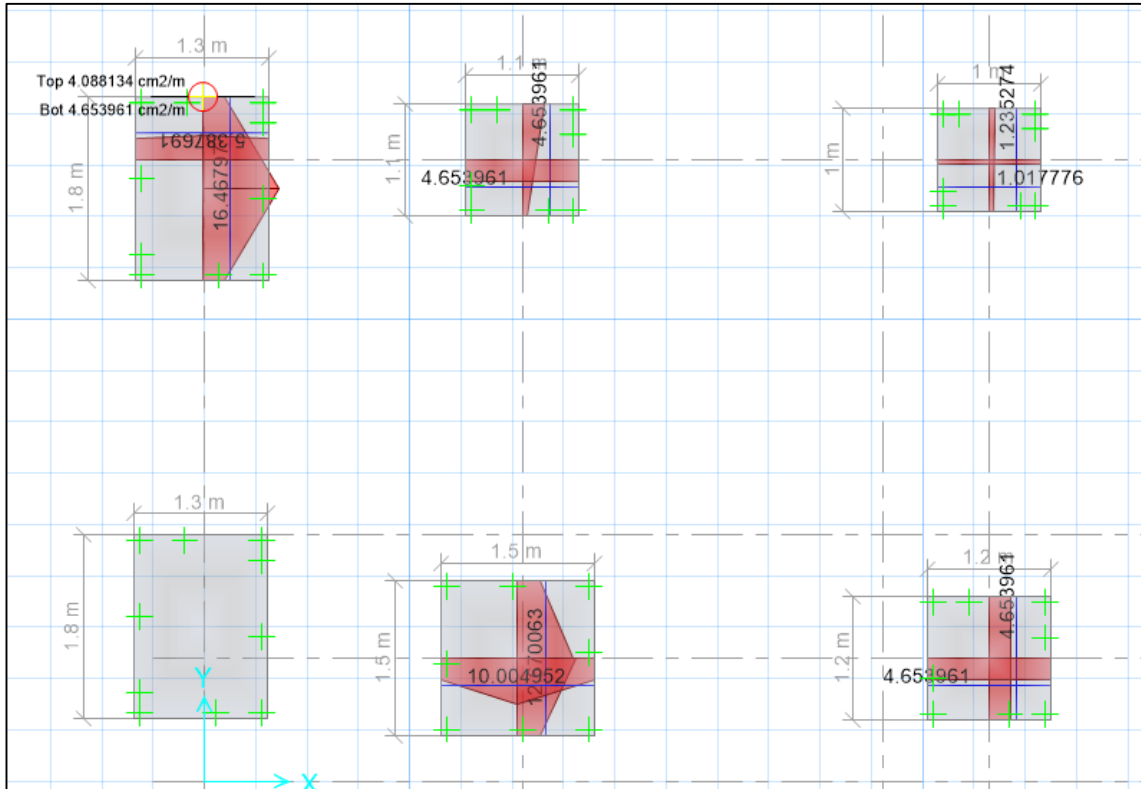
Cantidad de acero en cm²/m necesario para cada zapata tipo
